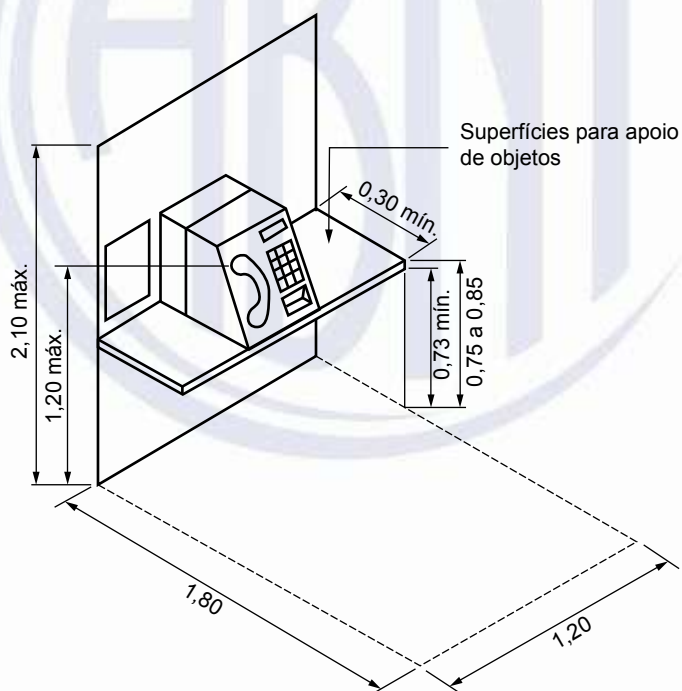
Telefone acessível – Medidas para instalação e área de aproximação – Perspectiva
